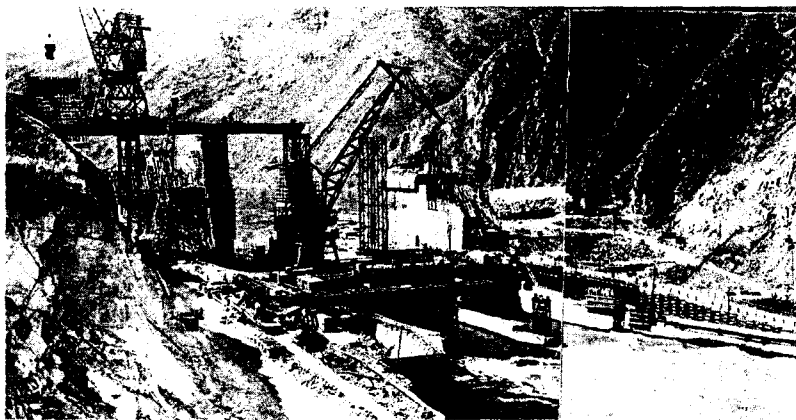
Монтаж бетоноукладочных эстакад на сооружения первой очереди Бухтарминской ГЭС
